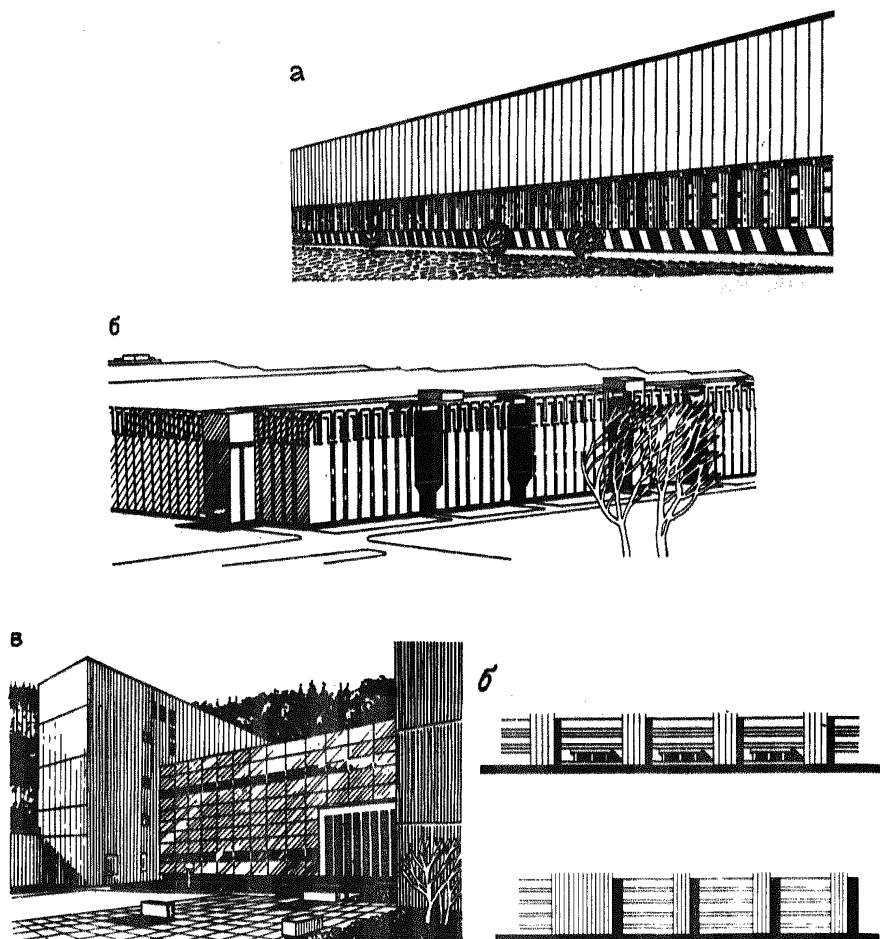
Примеры решения фасадов зданий, основанные на контрастном сочетании стеновых материалов
